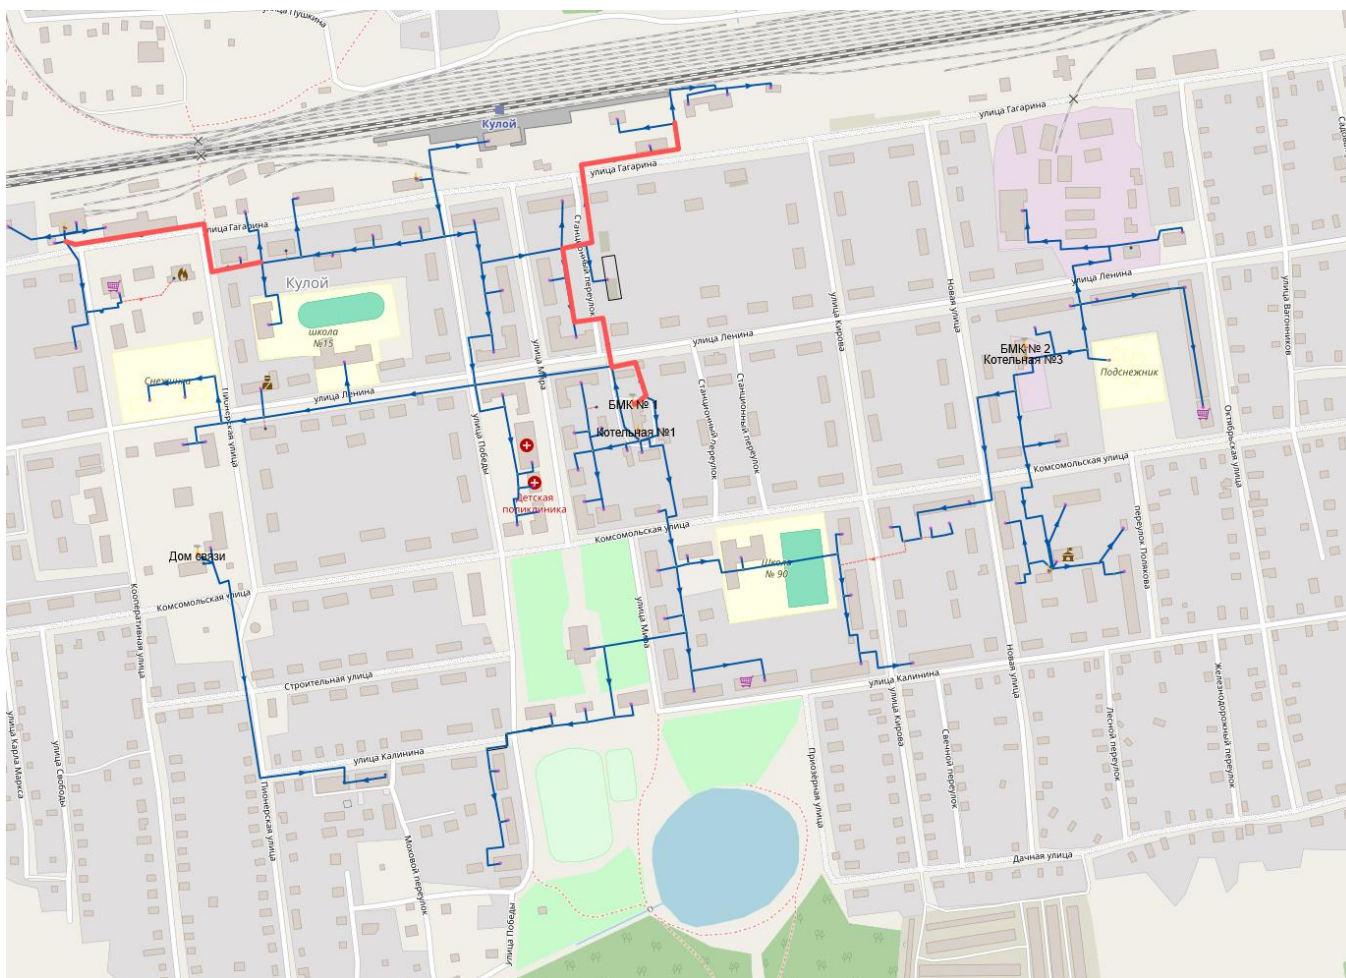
Переключение нагрузки котельной № 2, котельной «ПТО ВЧД» и котельной «ПЧ-24» на БМК № 1 (Сценарий № 2)
